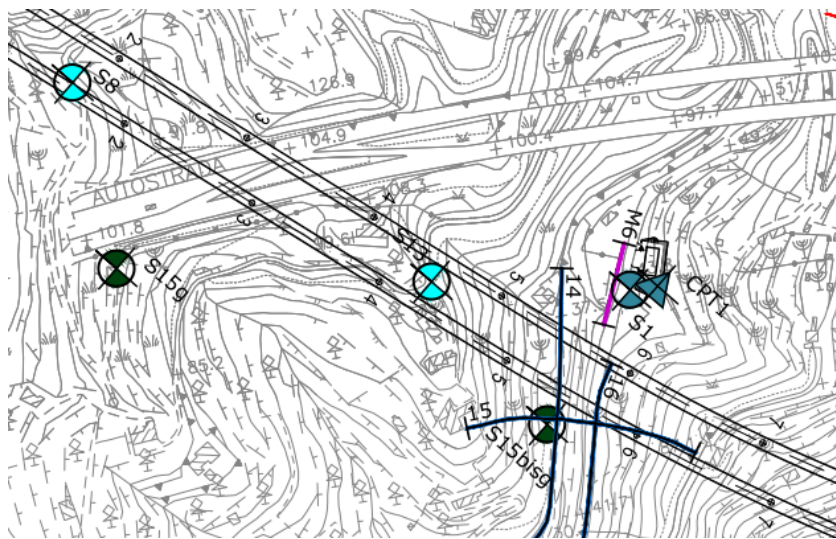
Stralcio planimetrico con ubicazione del sondaggio S13
